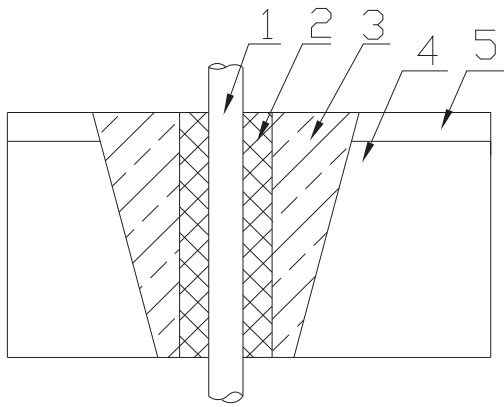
Виброизоляция трубопровода в месте прохода через перекрытие.
